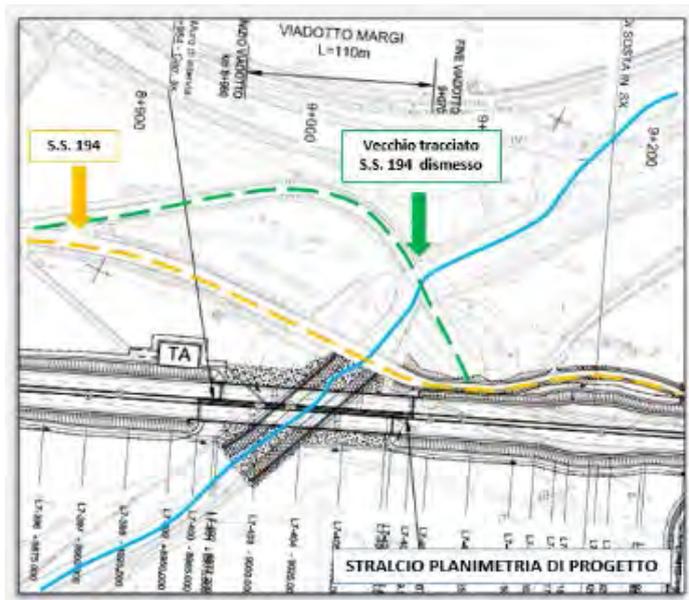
Lotto 7 Viadotto Torrente Margi Stralcio planimetrico
